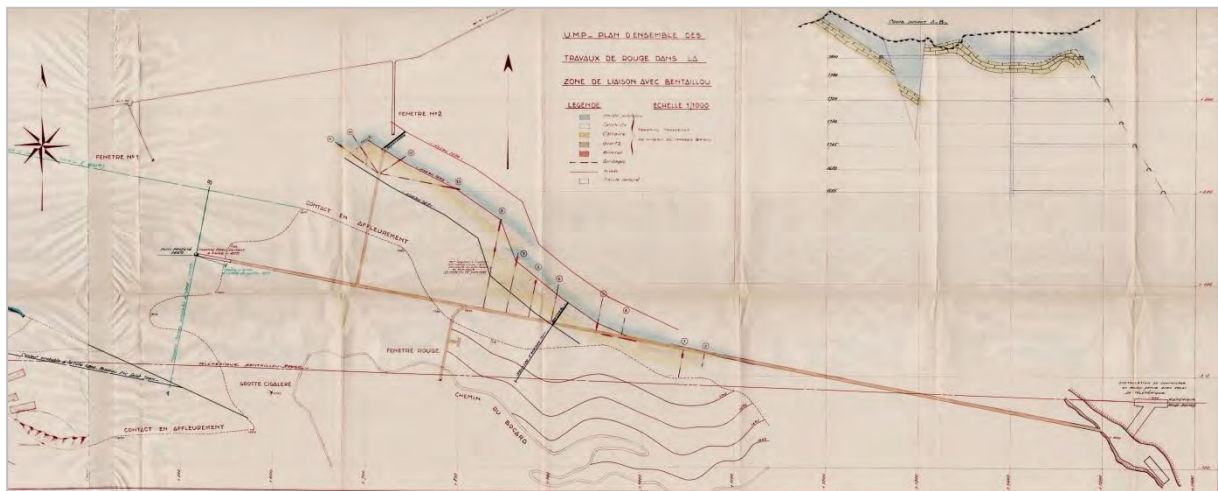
Organisation générale des principaux travaux du Quartier de Rouge et de quelques ouvrages de recherches satellites ; extrait d'un plan minier de l'UMP non daté [SEN-D-134]
